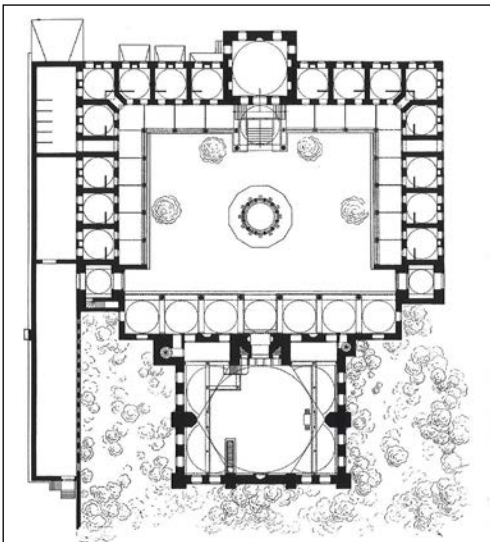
Sokollu Mehmet Pascha Moschee, Grundriss
